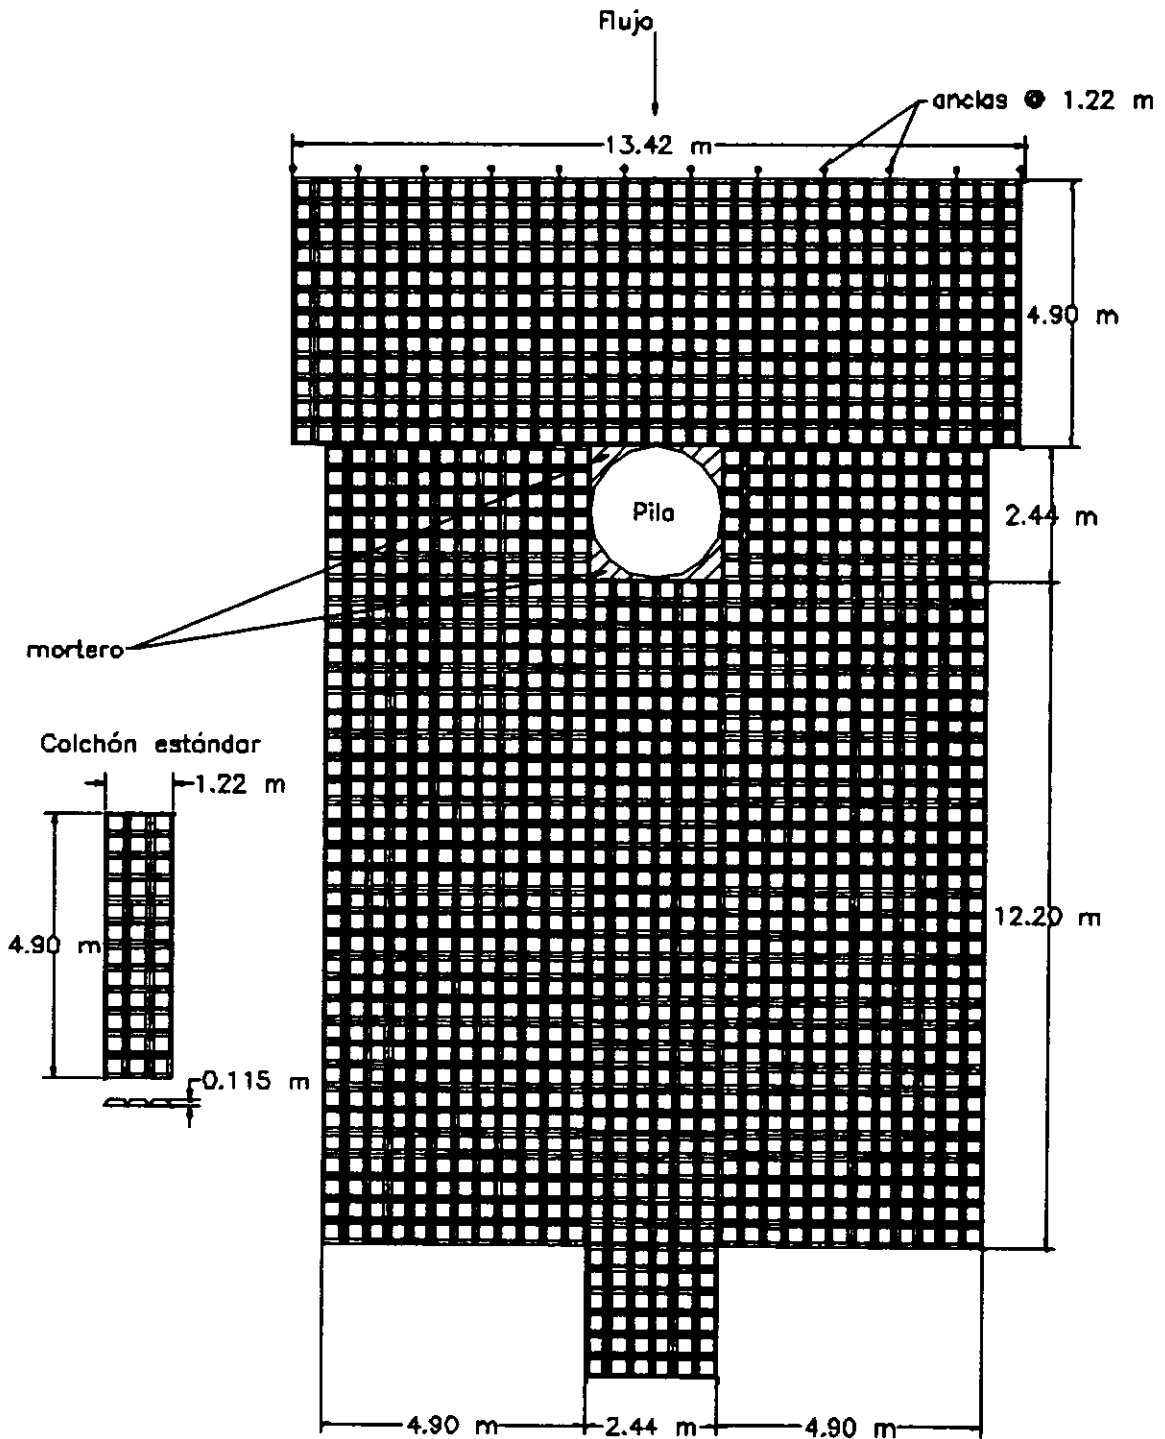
Arreglo propuesto para los colchones con bloques de concreto articulados, para la protección de la pila de puente del ejemplo.
